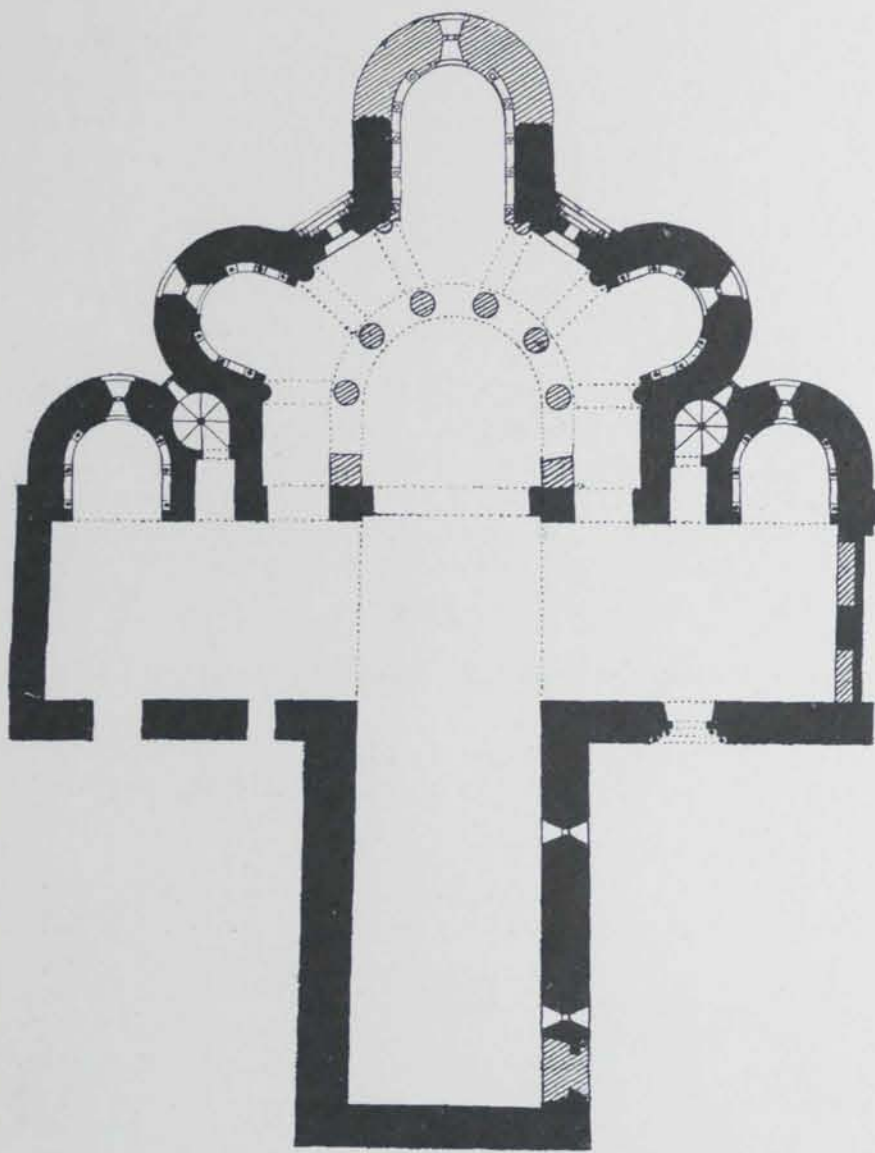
Plan de Sant Joan de les Abadeses. Restauració ideal Esc. 1 : 400
